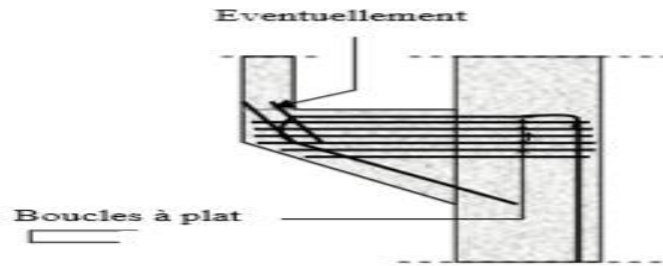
Disposition de ferrailage pour éviter la dégradation du corbeau.
